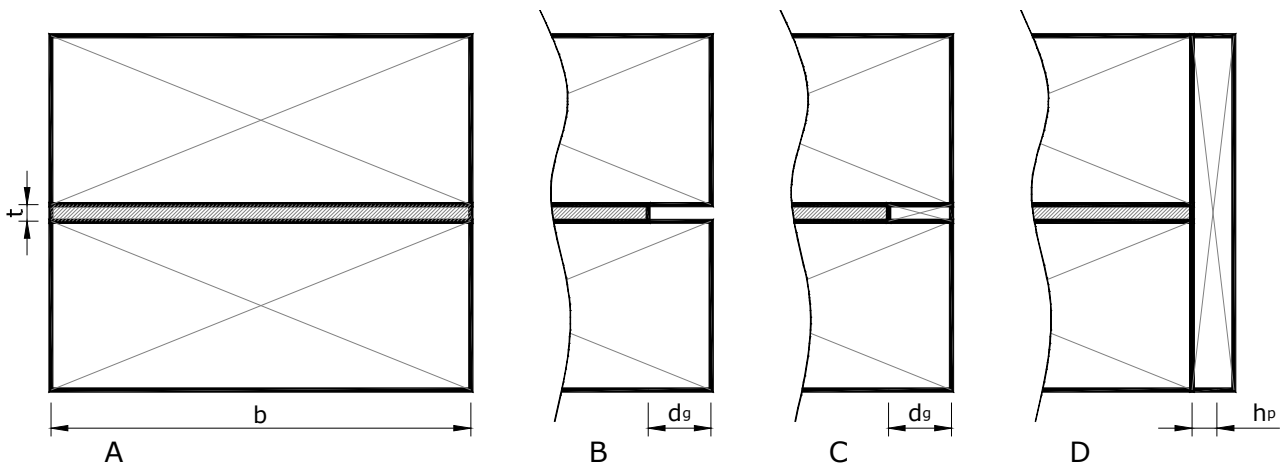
Protezione dei bordi delle piastre interne di acciaio.
